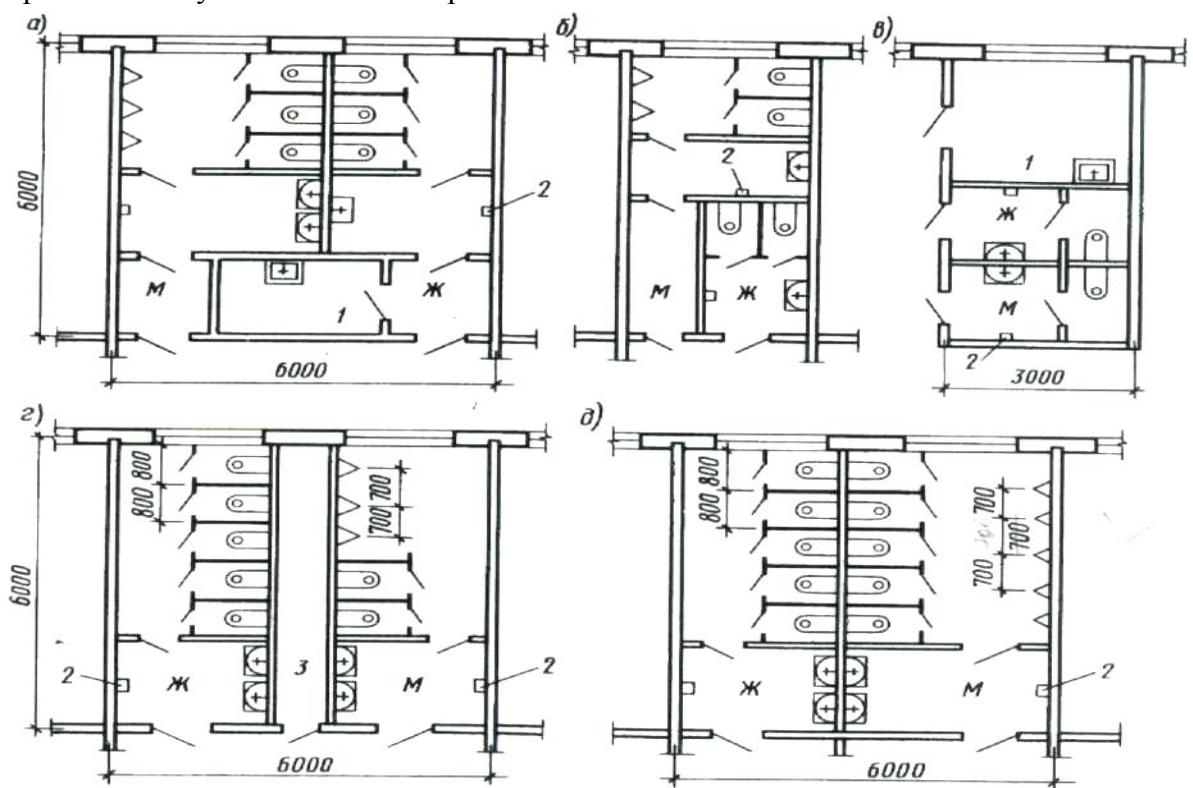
Приклади планувальних рішень санвузлів:
